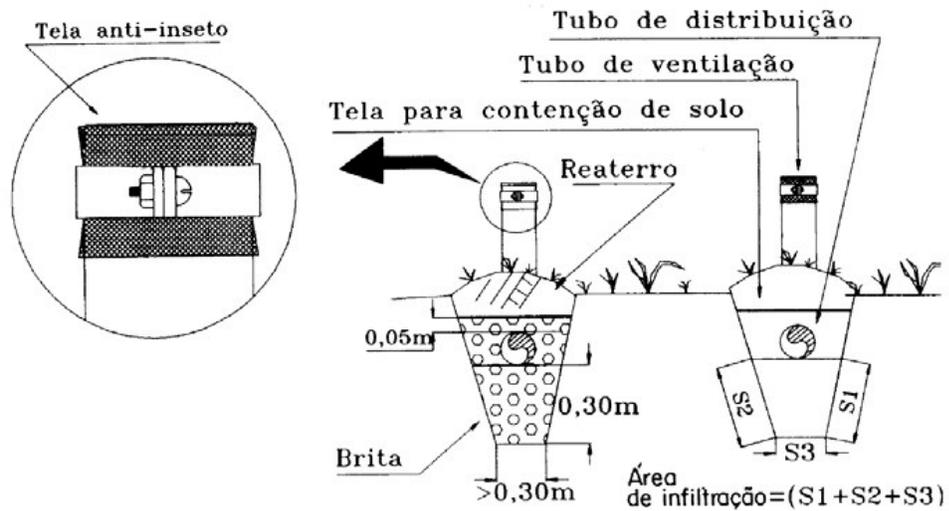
Detalhamento da Vala de infiltração subsuperficial – Corte transversal
